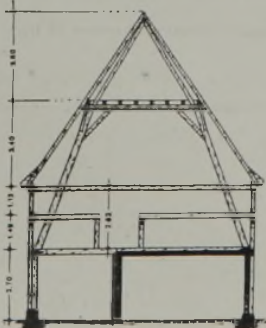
Querschnitt A—B zu den Grundrissen 12 und 13.
